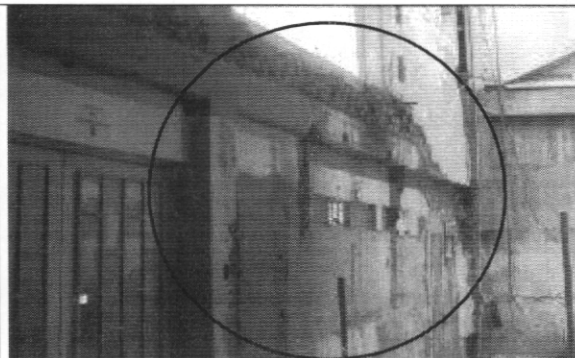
Desprendimiento de unidades en muro de fachada costado sur
